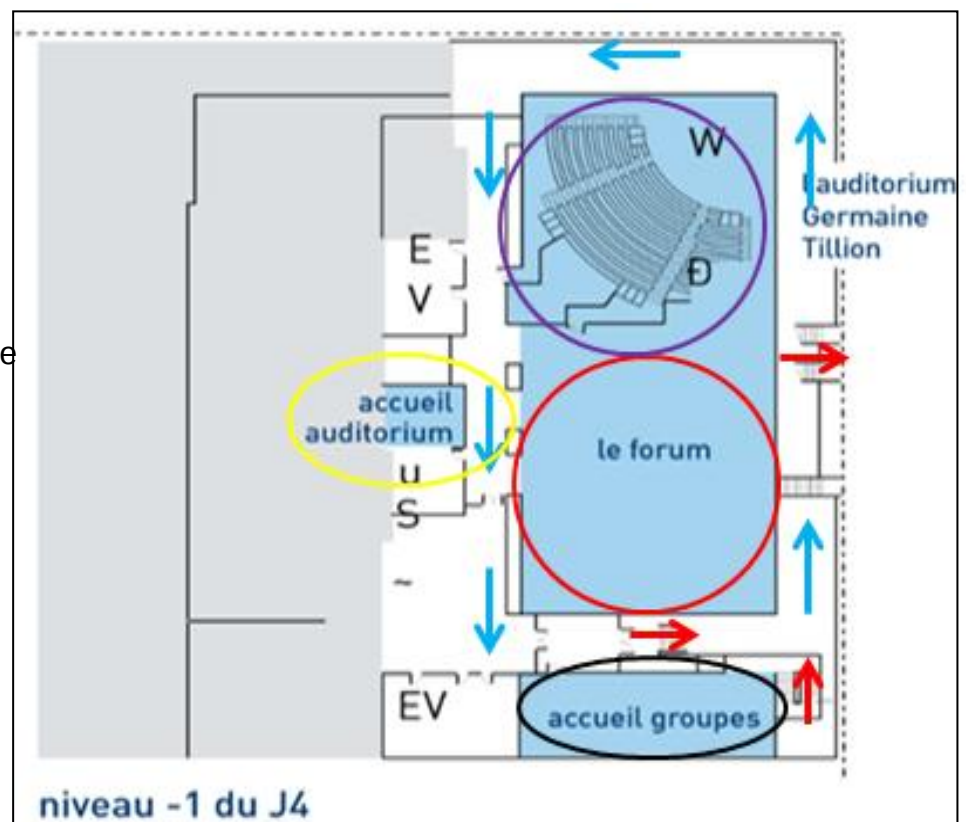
plan musée méditerranée, Source : <https://www.pinterest.fr/claraleandrasim/atc-mucem/?lp=true>
